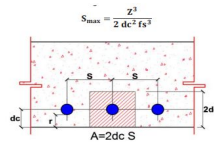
Esquema para el cálculo del espaciamiento máximo para control de fisuras
